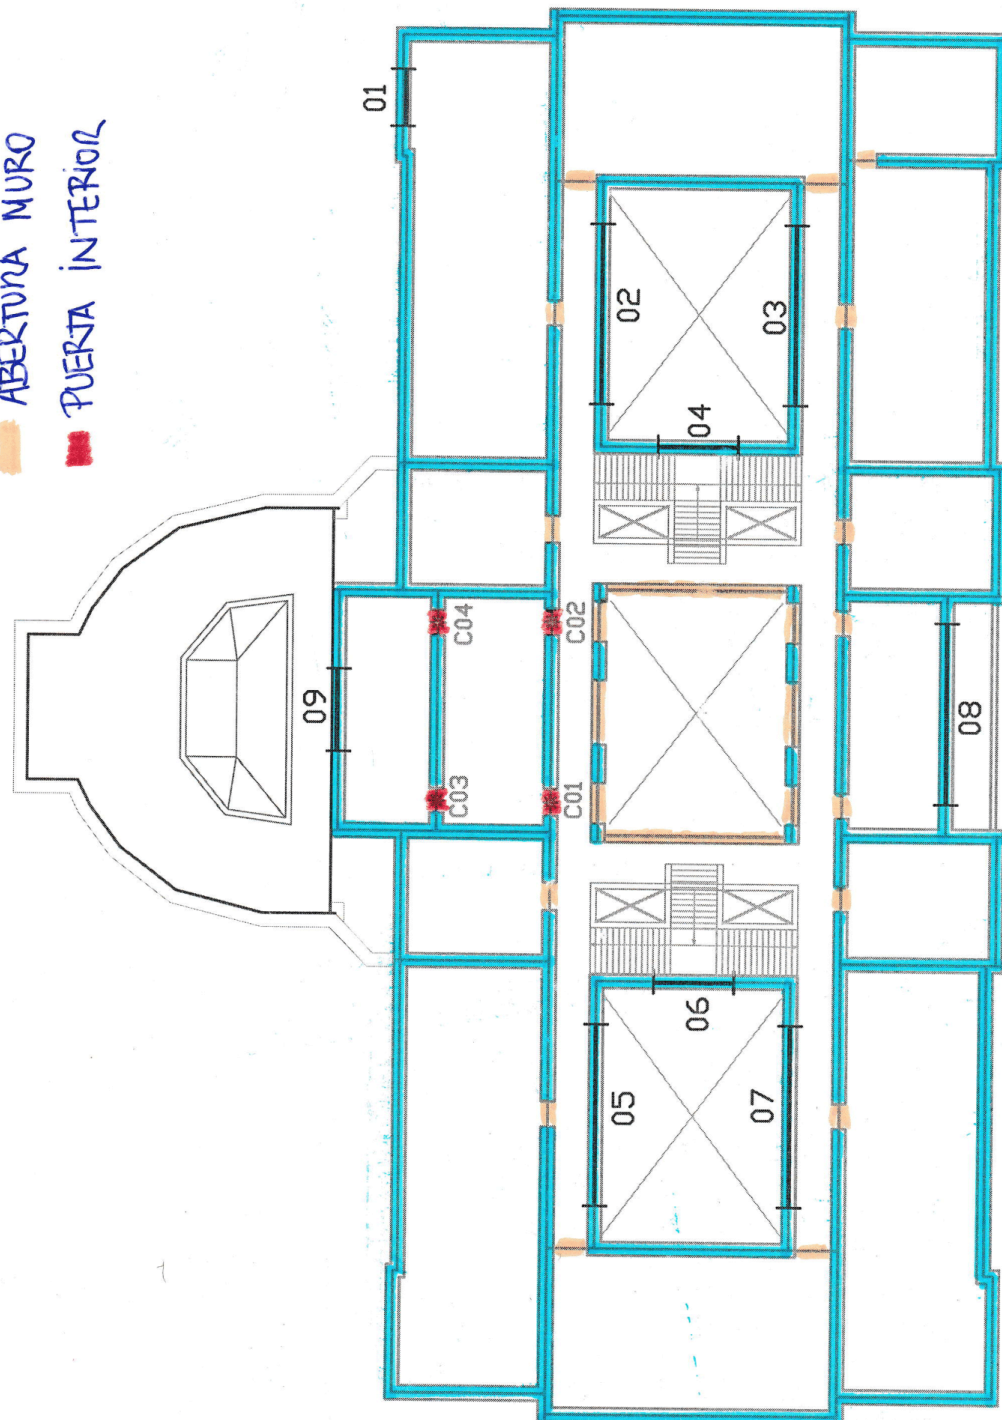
Distribución de muros, aberturas y puertas piso 2.
